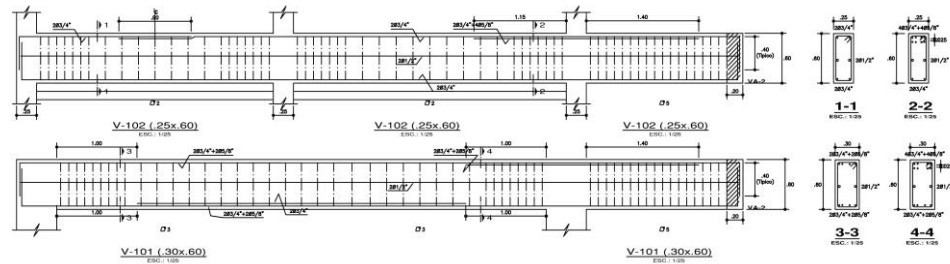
Disposición de las vigas principales del 1er nivel del módulo 780 reforzado.
